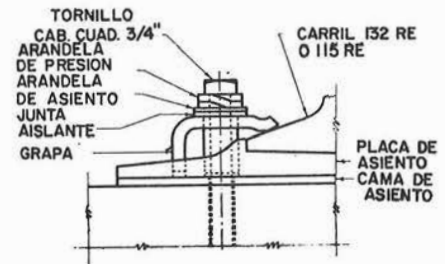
Detalle de sujeción. Proyecto de la AAR.
